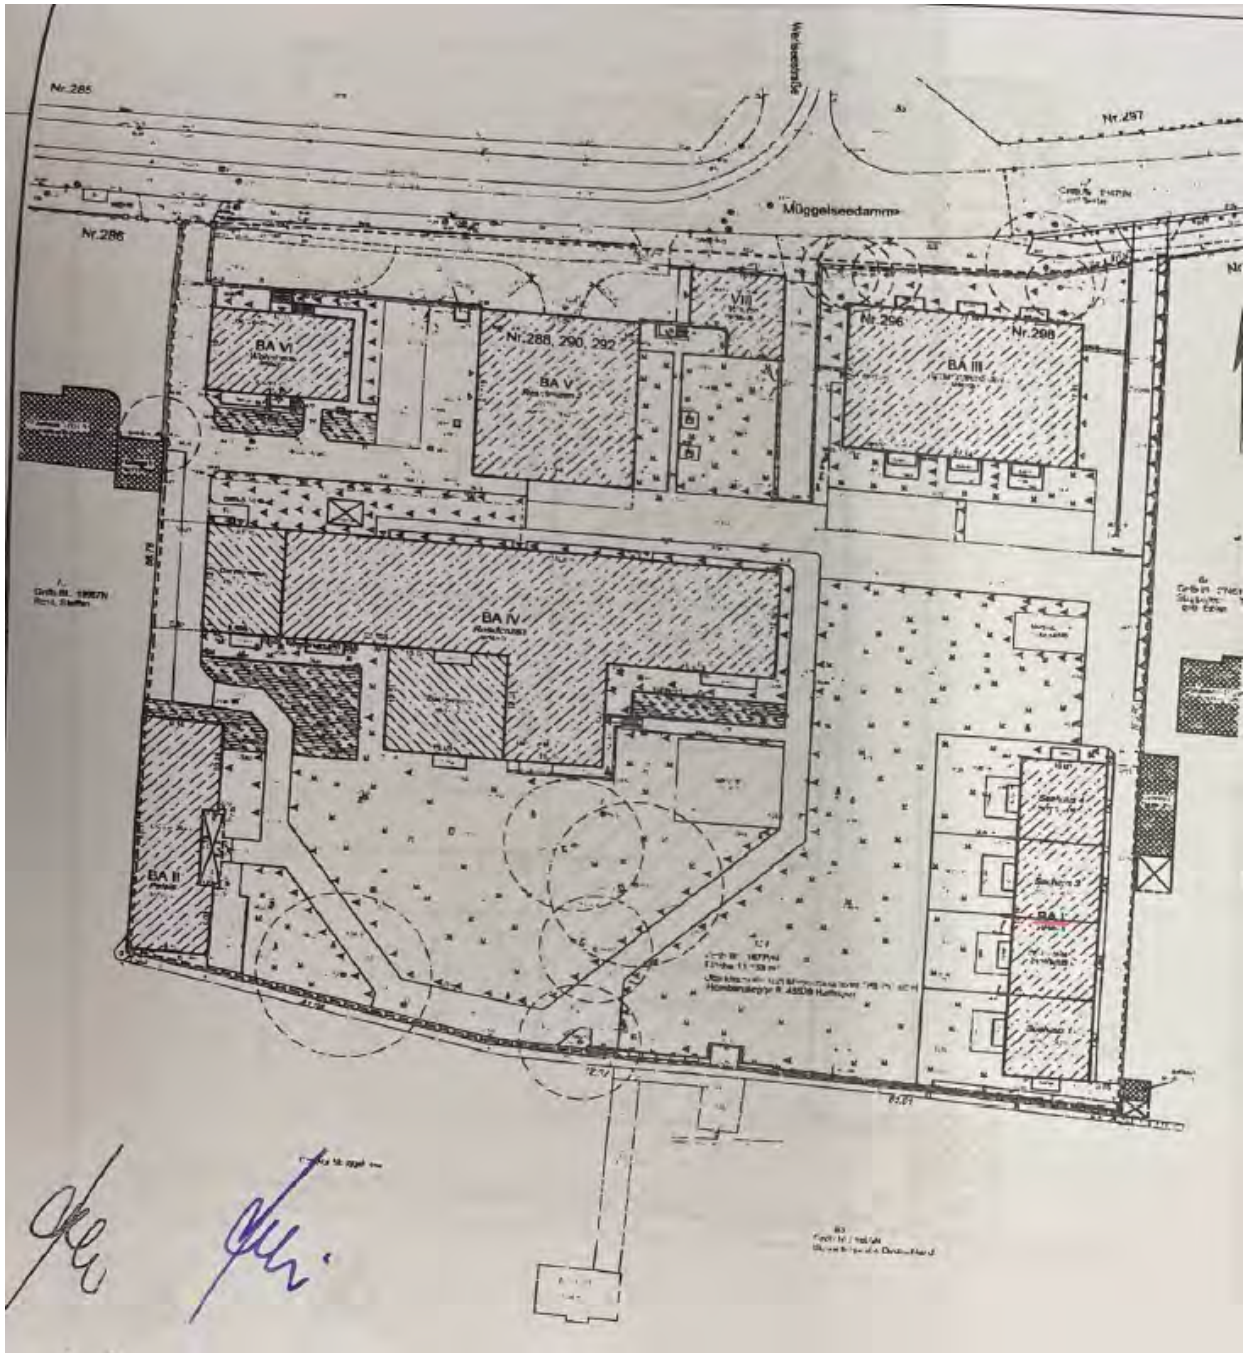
Lageplan zur Teilungserklärung mit Markierung der Lage der Wohnung Nr. IV/2 im EG
